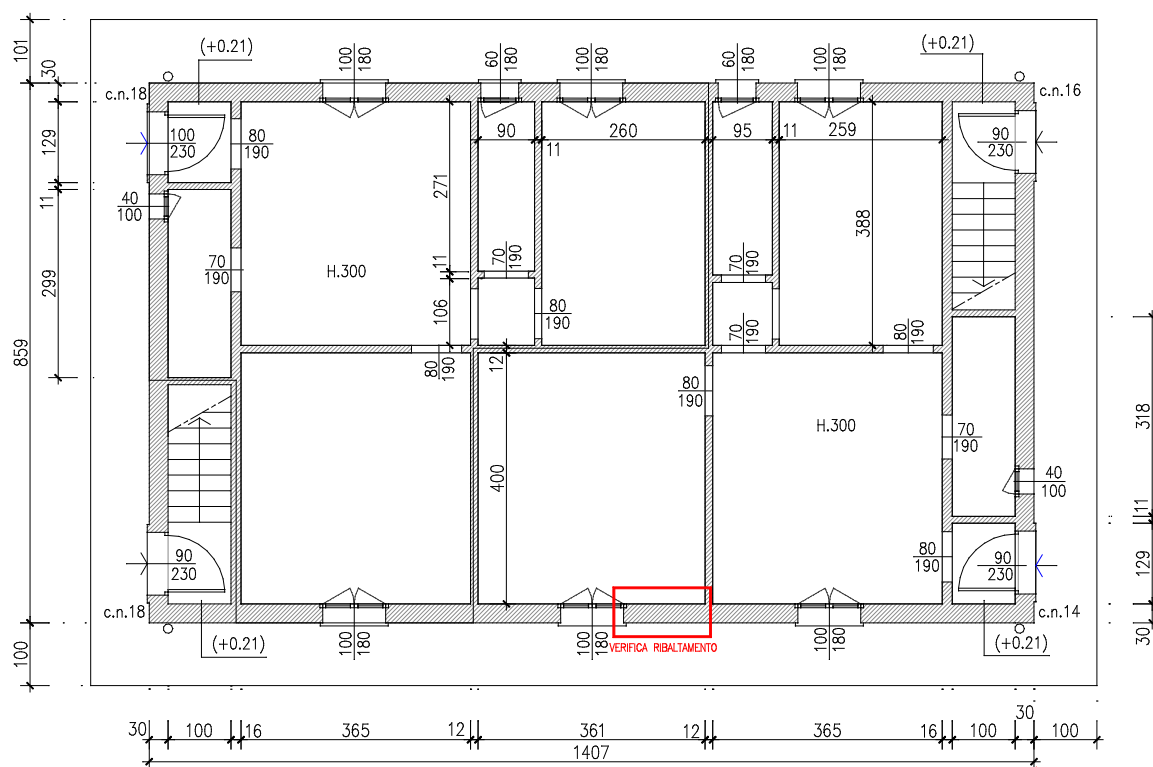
Palazzina C – PIANO TERRA – Individuazione della parete oggetto di verifica
